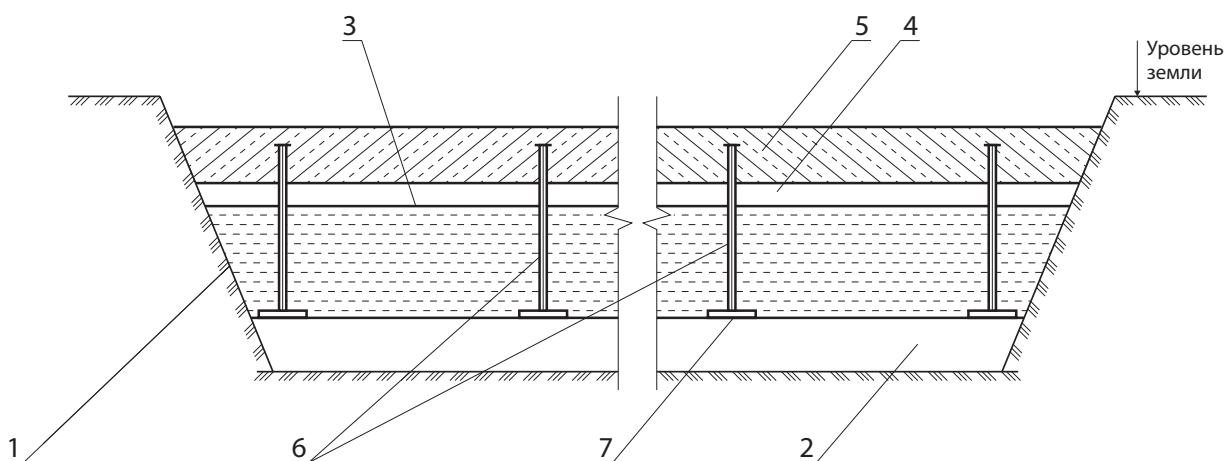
Разрез карты-шламонакопителя с укрытием отходов железобетонной плитой на основе наноцемента:
